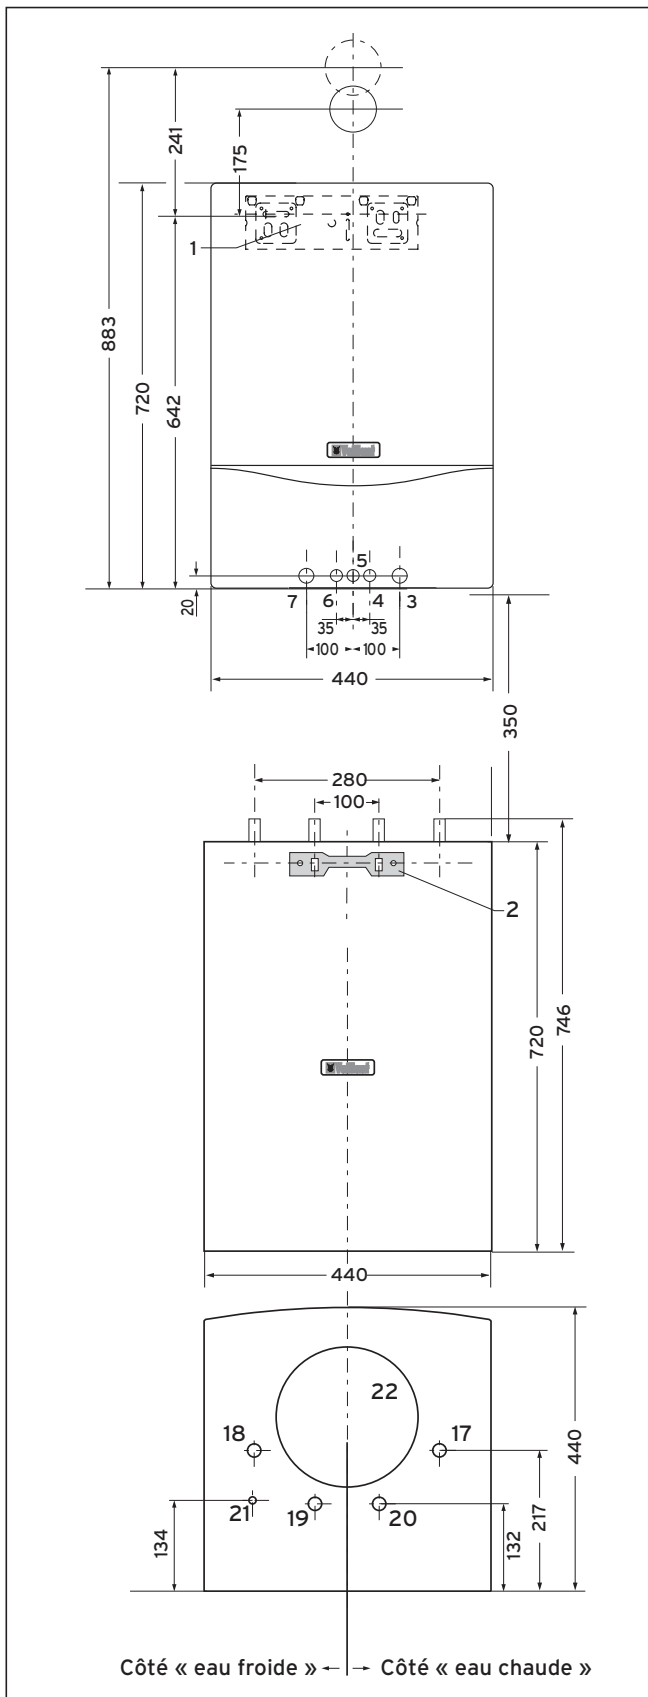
Dimensions pour le montage sous l'appareil de chauffage
